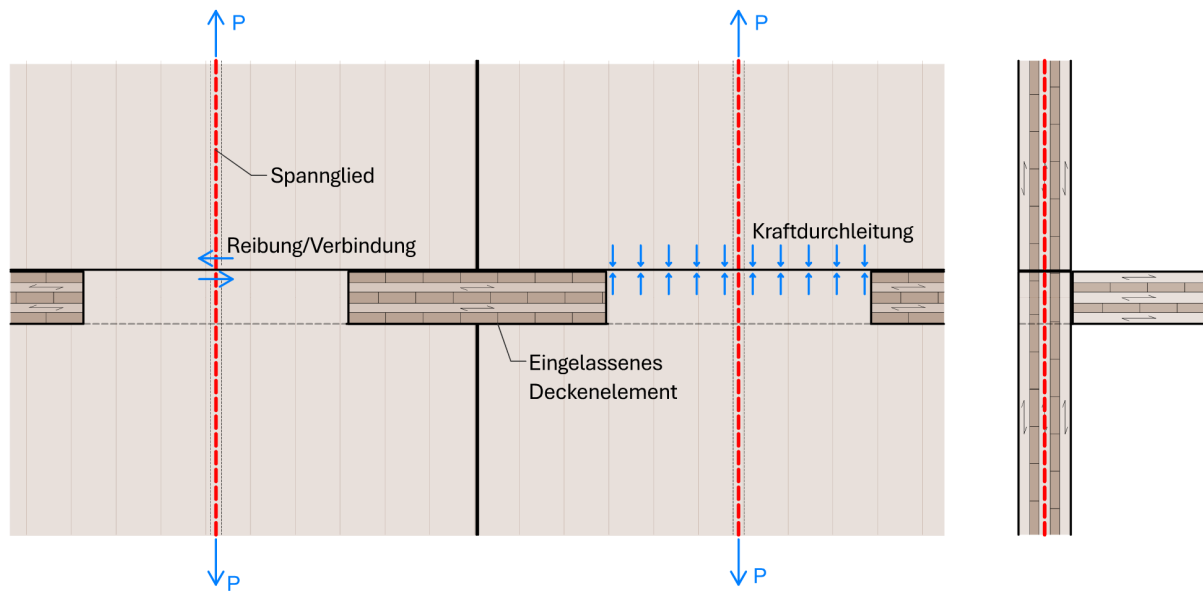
Schema für ein vertikal vorgespanntes Brettsperrholz-System
